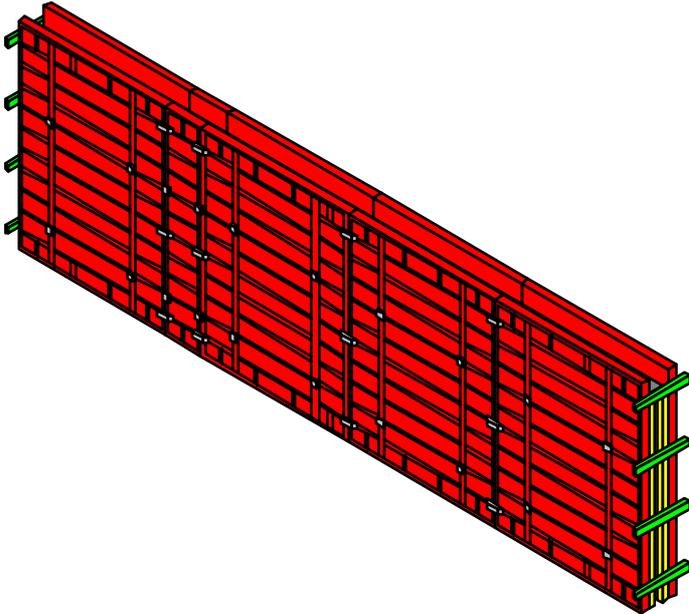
Beispiel Fertigungsabschnitt Stahlbetonwand eingeschalt¹⁰¹
